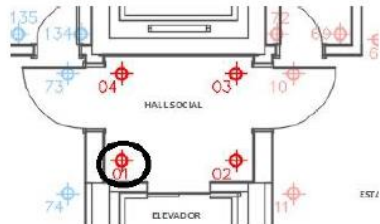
Ponto 1 no projeto de planta de mapeamento
